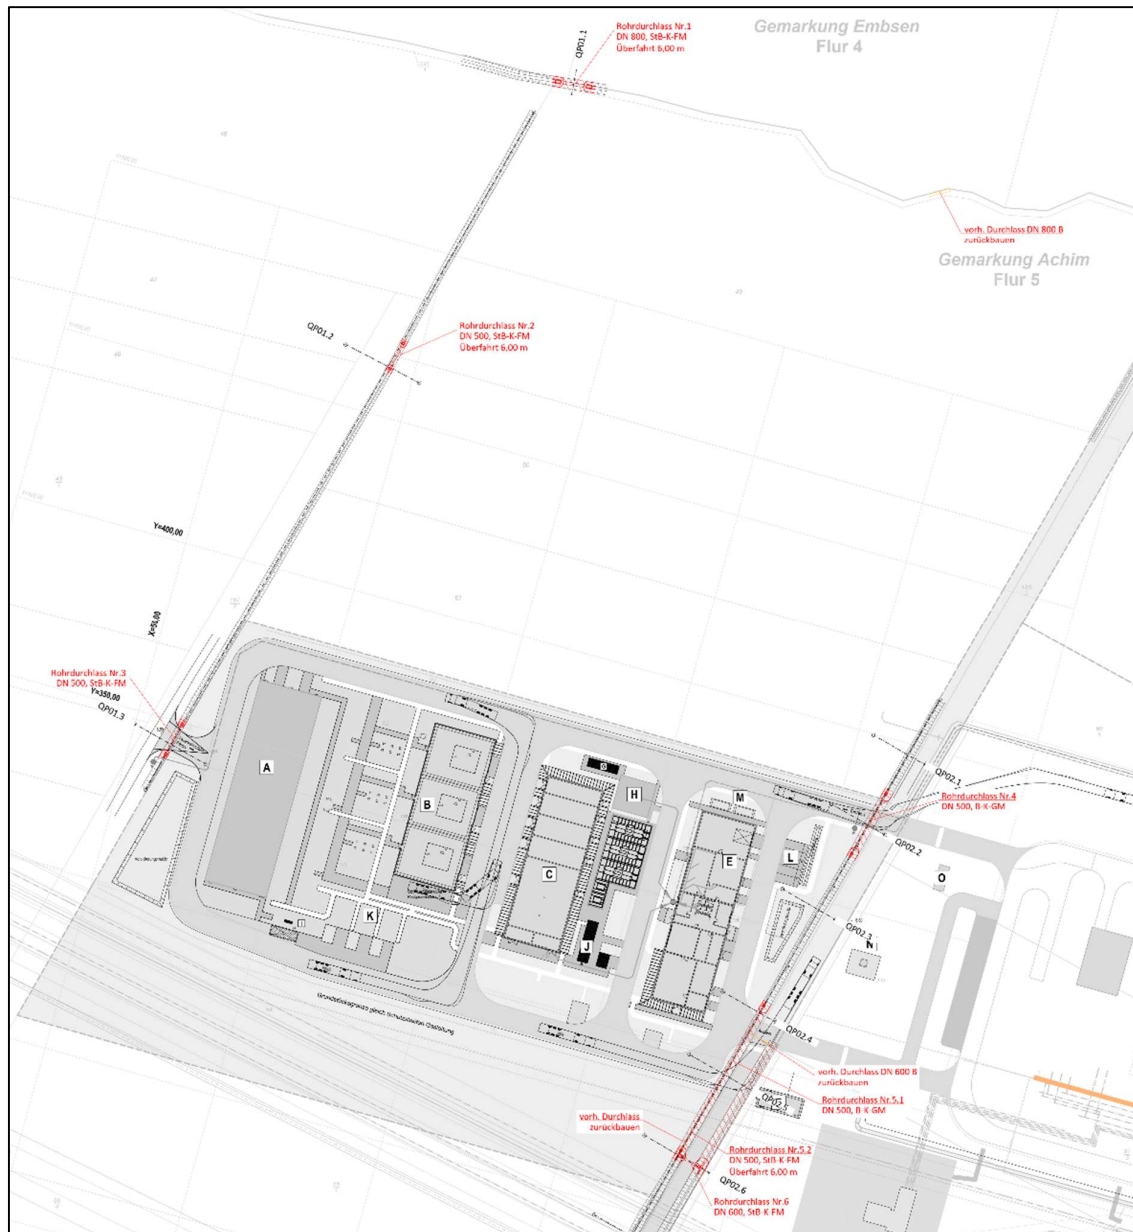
Lageplan Grabenteilverrohrungen (Quelle: Heidt und Peters, 2024)
